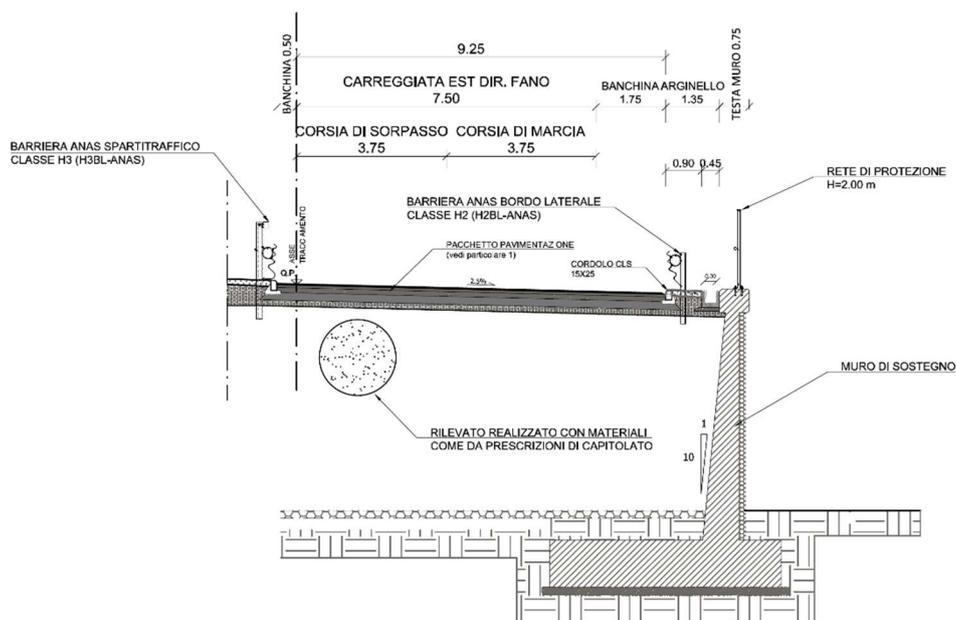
Sezione tipo in rilevato – Muro di sostegno con canaletta idraulica
